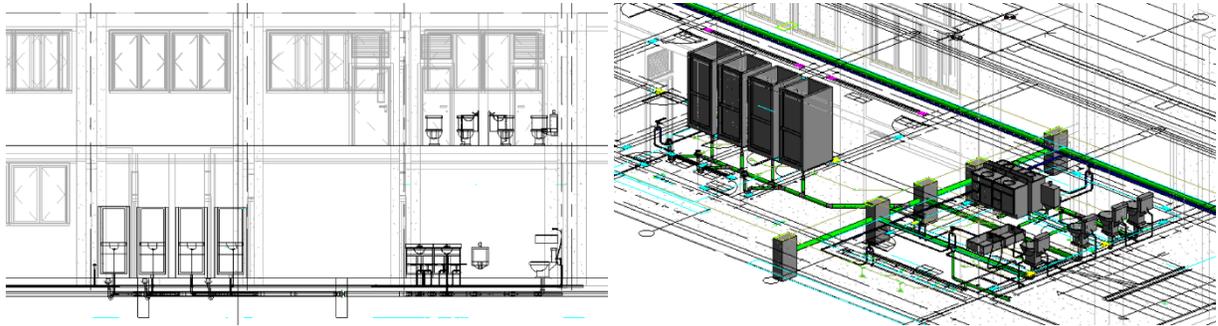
Modelado MEP Instalaciones Sanitarias Planta Baja (REVIT)
